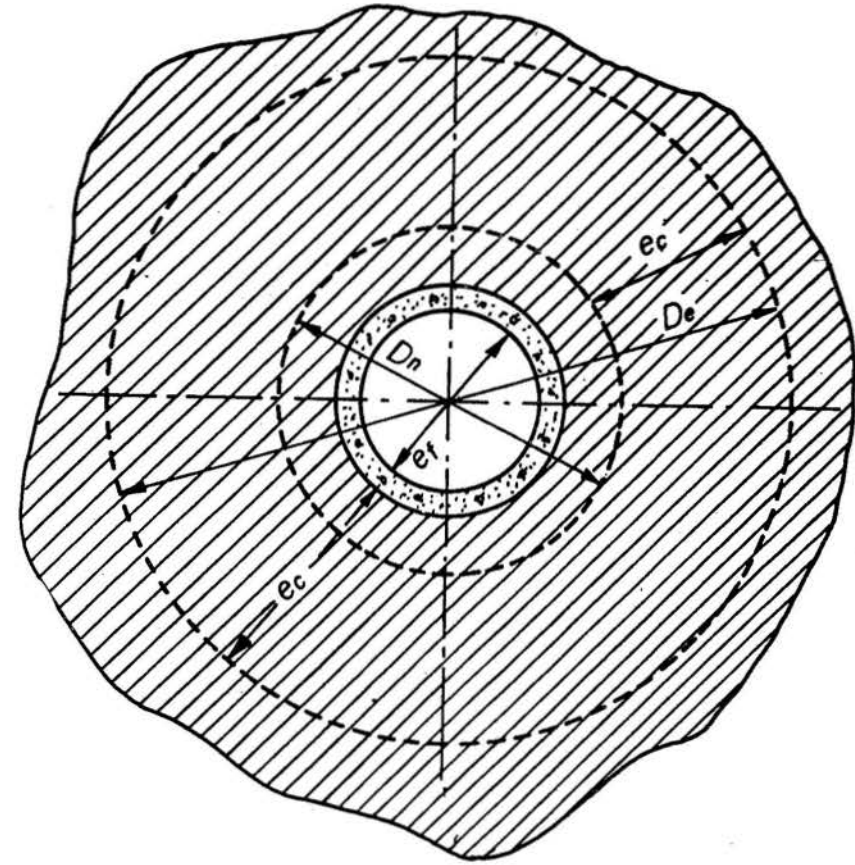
Esquema para el cálculo de la cortina de aislamiento.
